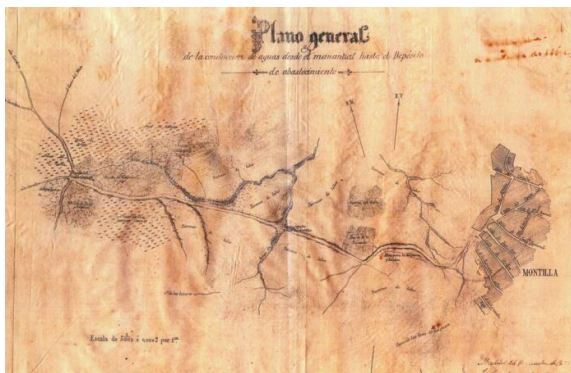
Plano general de la conducción de agua desde el manantial hasta el depósito de abastecimiento (sacado de Sánchez-Molero, 1868).
